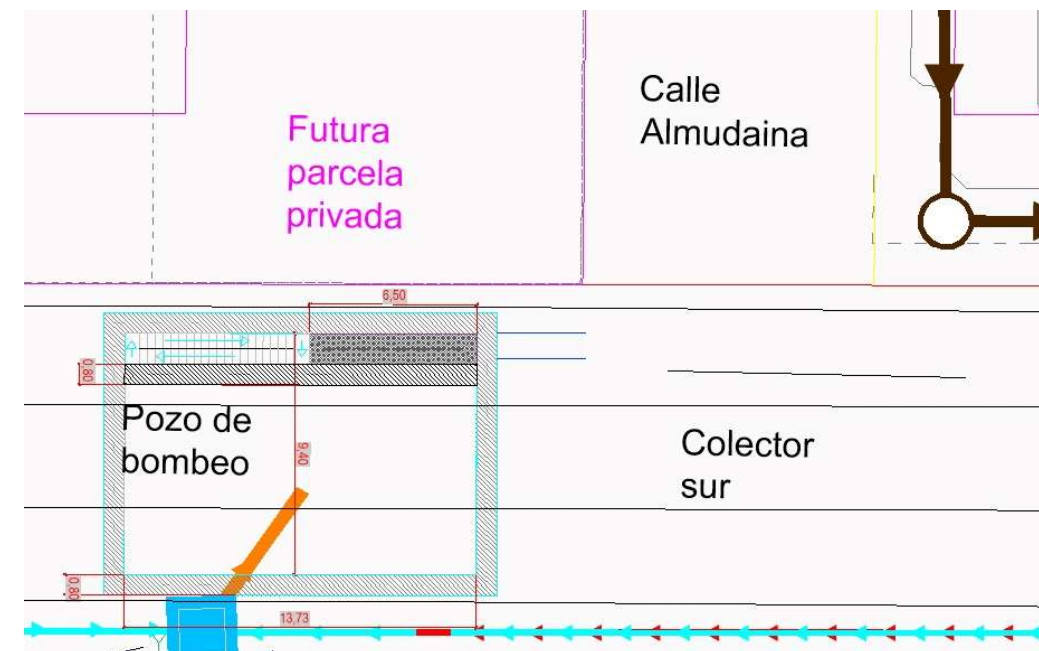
Entorno del Pozo 6. Fuente: elaboración propia con planos de la oficina técnica
